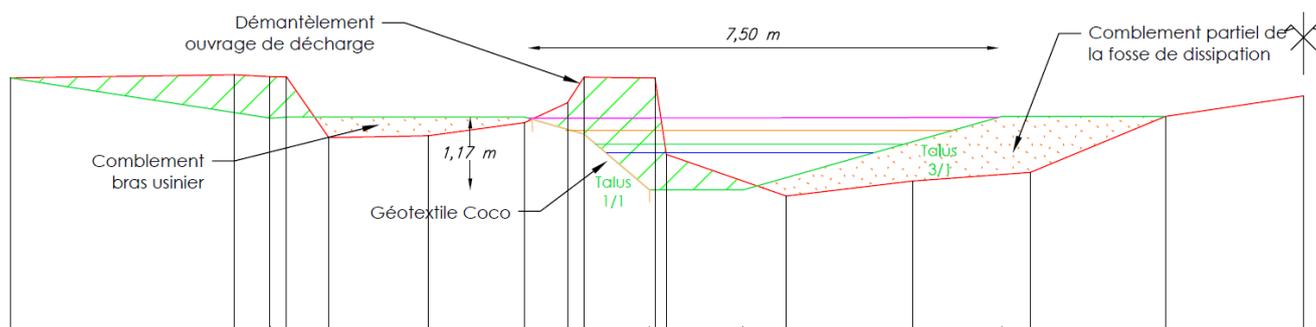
Profil en travers au droit de l'ouvrage de décharge (PT17)
